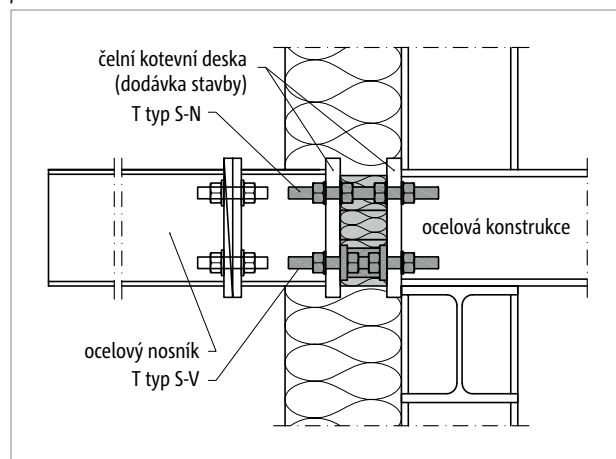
Schöck Isokorb® T typ S-V: Podepřená ocelová konstrukce
